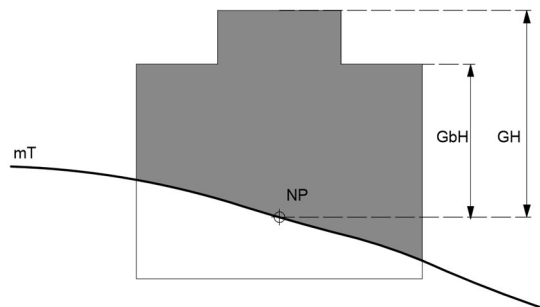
Gesamt- und Gebäudehöhe Flachdach
